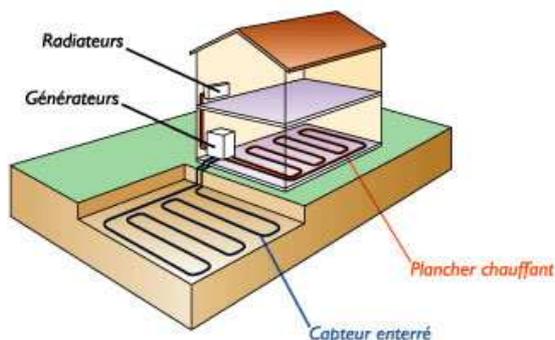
Installation avec sonde géothermique horizontale (Source : BRGM)
